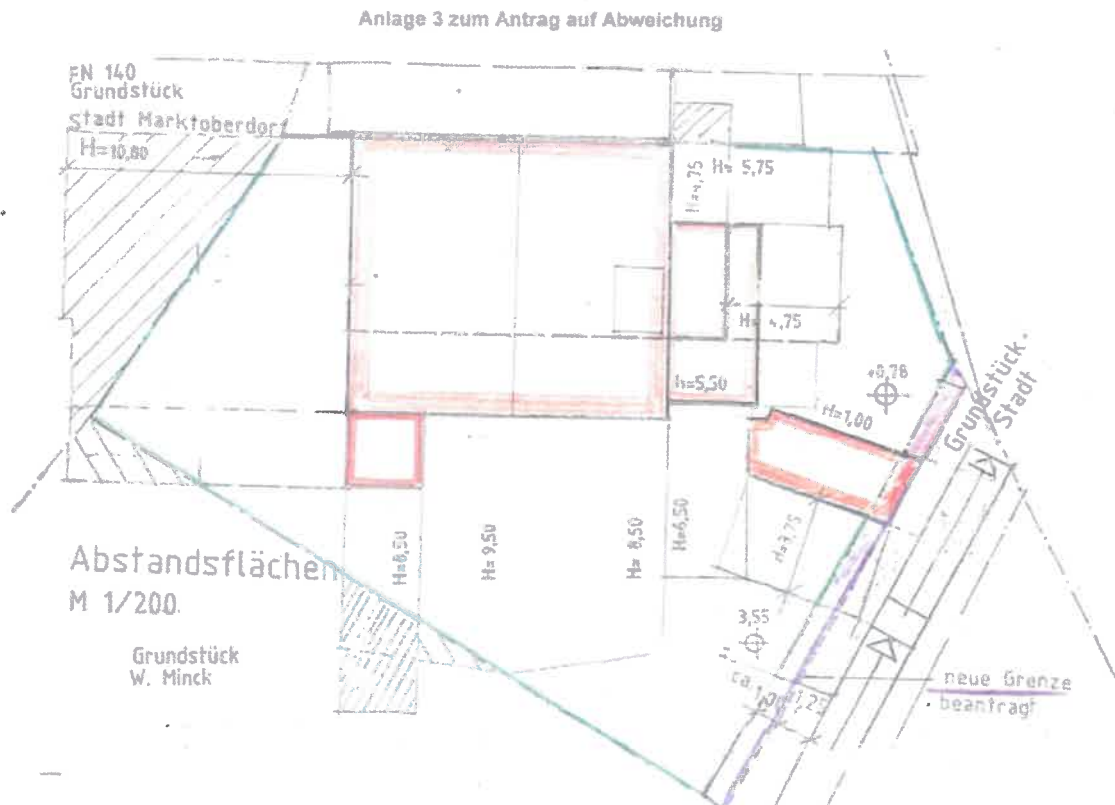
Abweichungen BPlan Nr. 44 „Kurfürstenstraße“: Unterschreitung der Abstandsflächen Doppelhausbebauung
